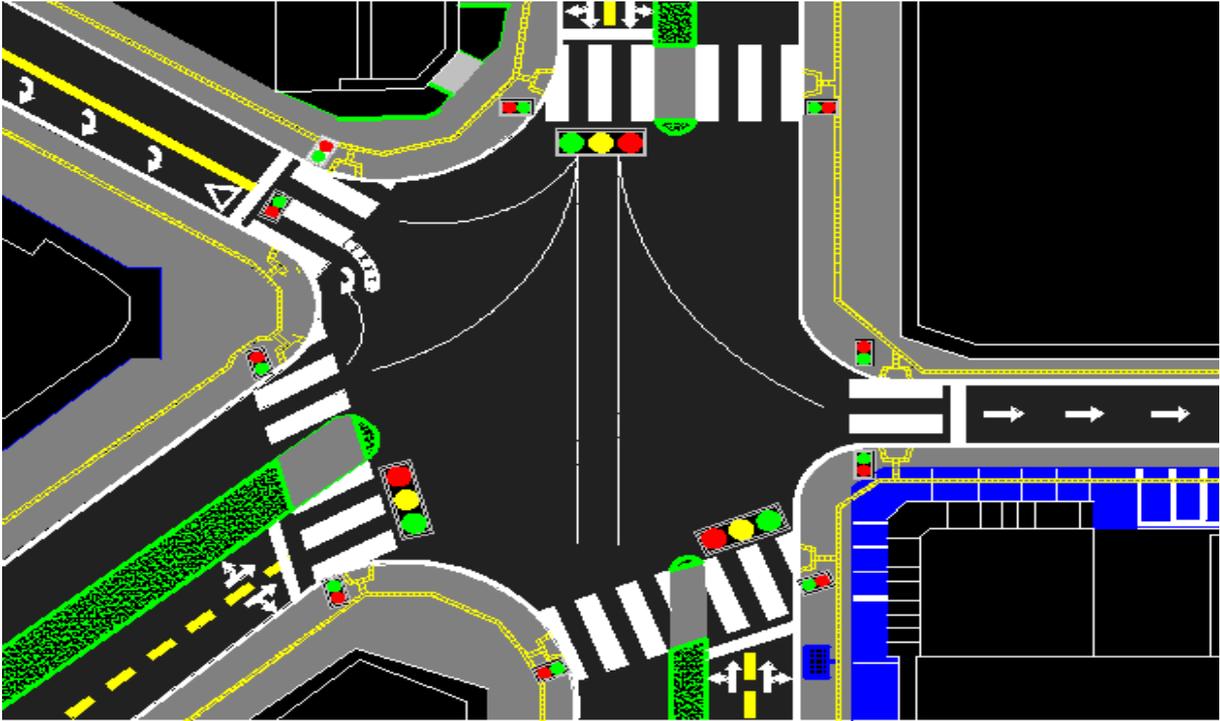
Possível travessia – Avenida Pio XII (PRAÇA)
